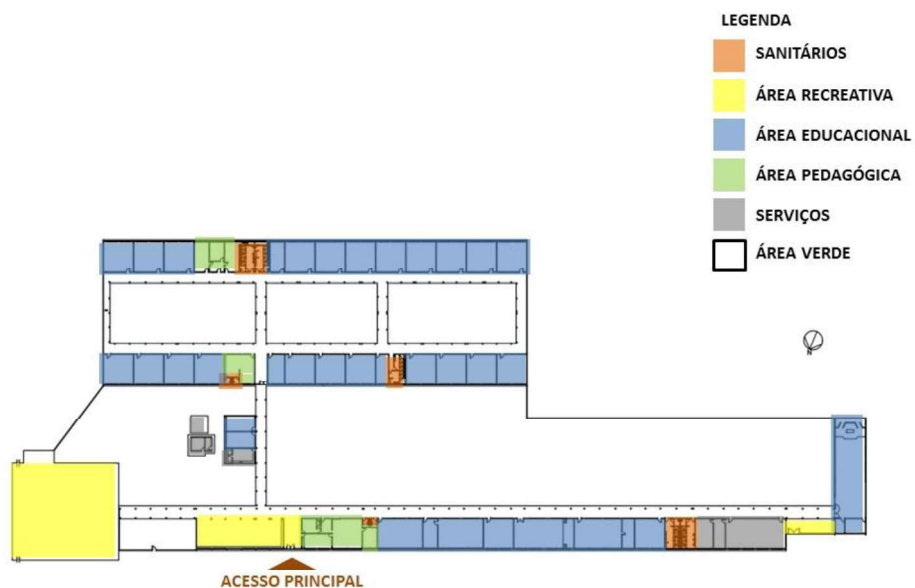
Planta baixa- Escola Estadual Maria José Loureiro, com setorização
